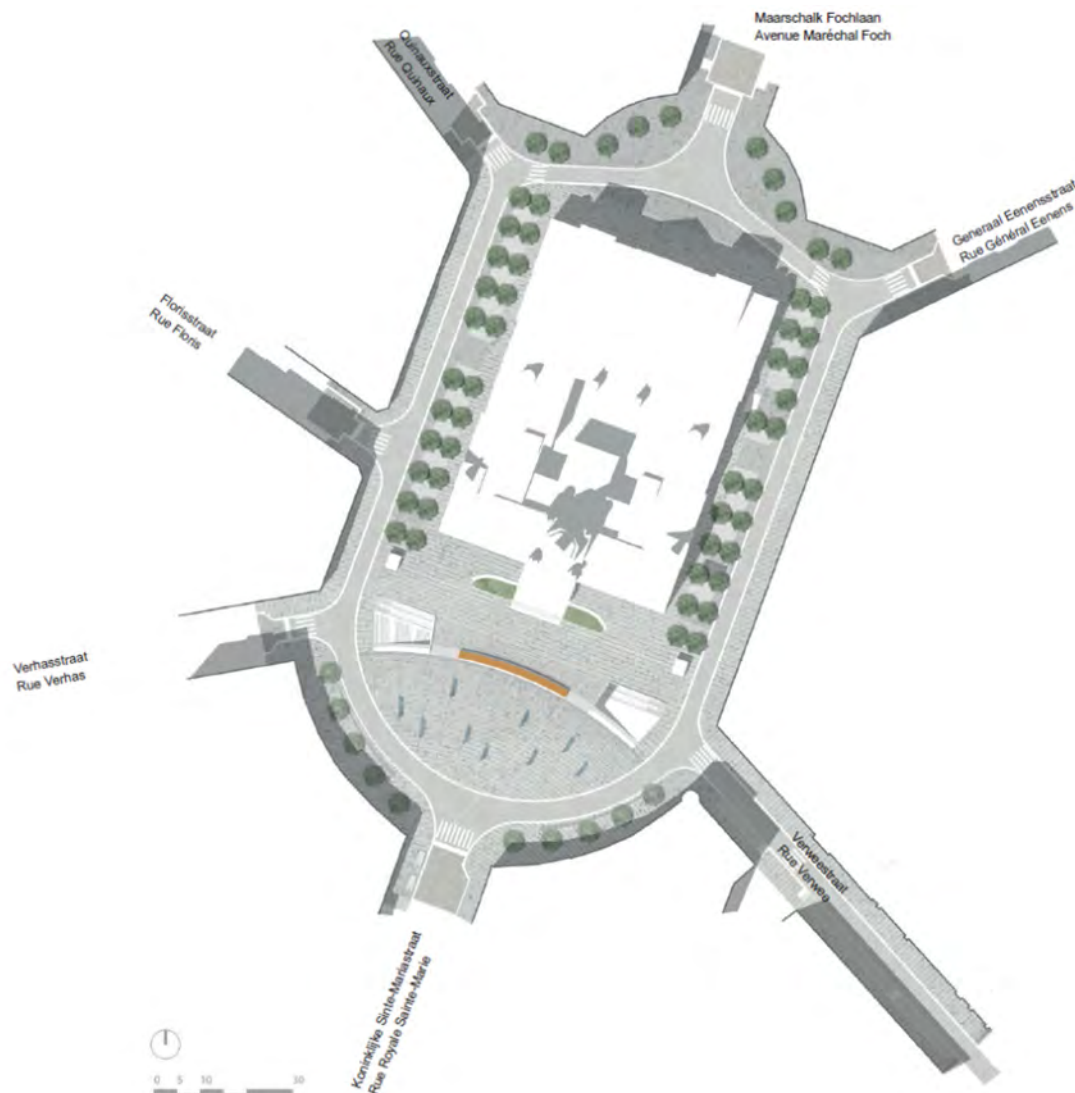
Aanzicht op plan van de nooduitgangen en liften (BMN, 2018)
